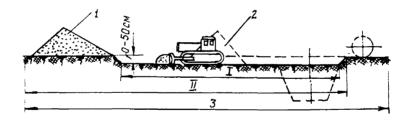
Схема разработки и перемещения гумусового слоя грунта бульдовером при технической рекультивации строительной полосы:
